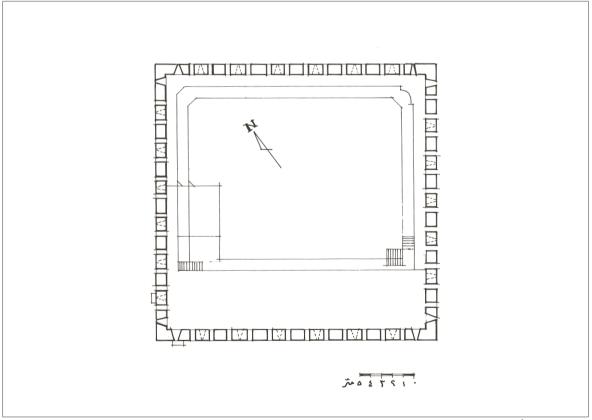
مسقط أفقى للطابق الأرضى من قلعة ذات الحاج.
